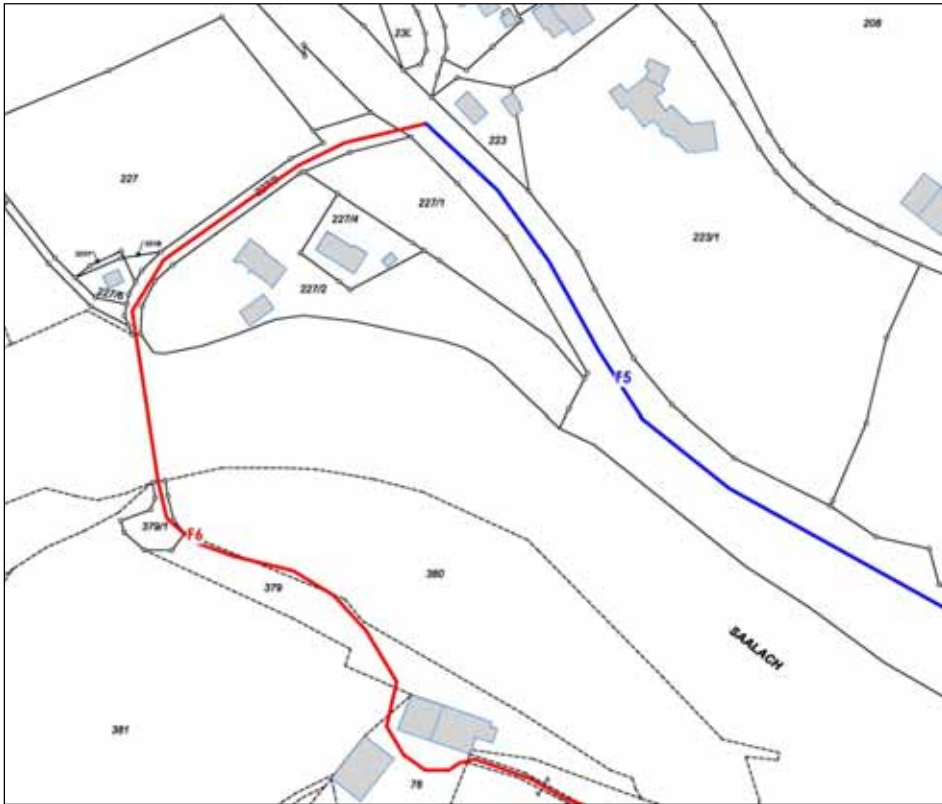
Lageplan mit Darstellung der Schallquellen für die Baustellenzufahrt V2
